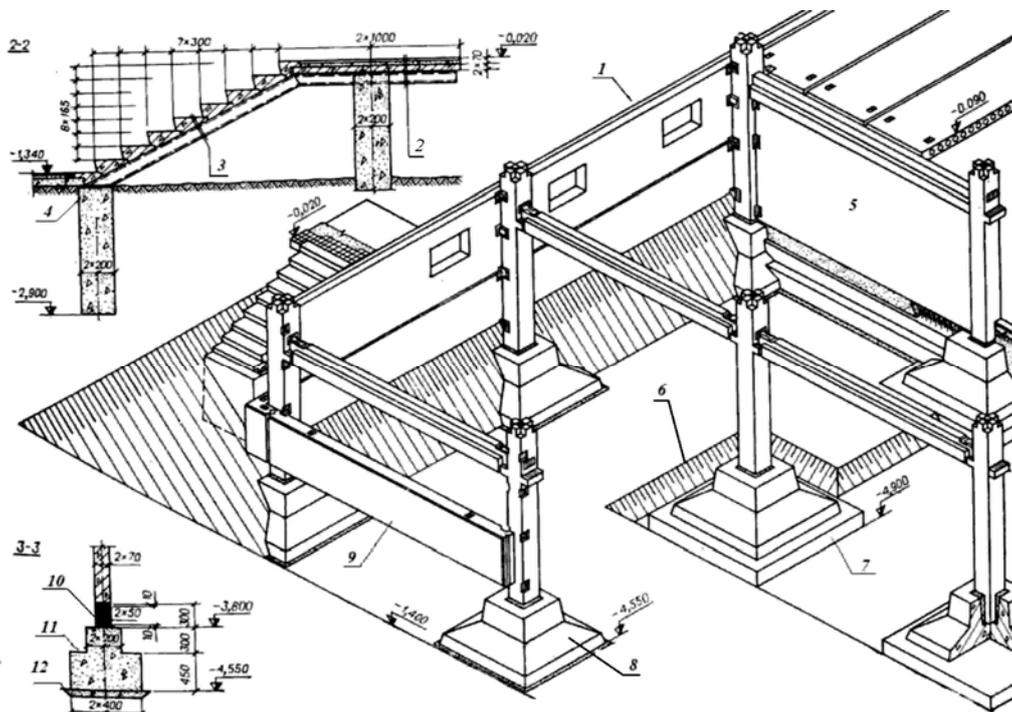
Общий вид отдельно стоящего фундамента: 1 — цокольная панель из керамзитобетона марки 75; 2 — керамическая плитка 6, цементный раствор 14, бетон марки 5а 50, ж/б плита 70, двутавр № 14, обетоненный по стальной сетке; 3 — ж/б ступени, косоуры, двутавр № 14, обетоненный по стальной сетке; 4 — монолитный фундамент из бетона марки 100; 5 — диафрагма жесткости в плоскости рам каркаса; 6 — грунт в подвале, который условно вынут до уровня подошвы фундаментов; 7 — монолитная ж/б плита марки 100; 8 — сборный ж/б фундамент Ф1; 9 — панель стены подвала из бетона марки 200, которая устанавливается на монолитные подставки; 10 — замоноличивание бетоном марки 200; 11 — бетон марки 100; 12 — бетон марки 50
